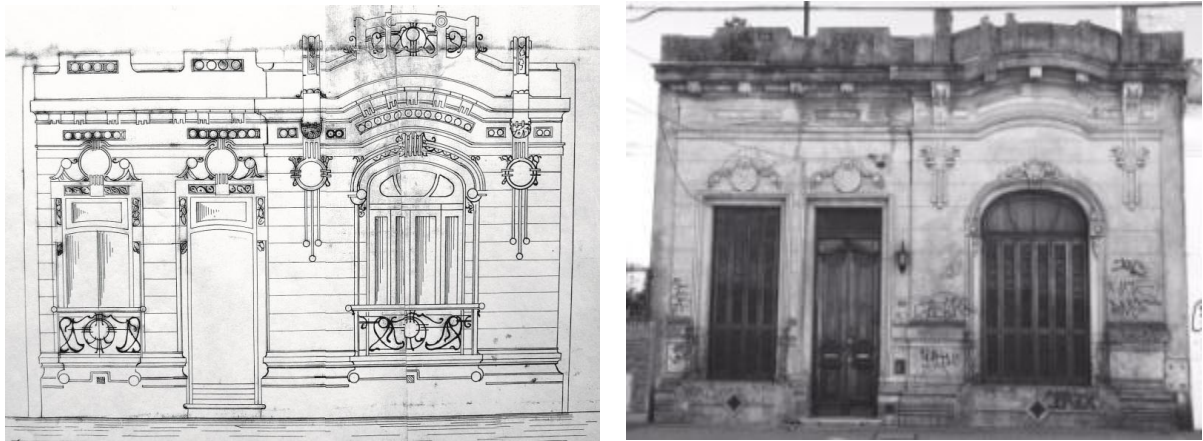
Detalles de fachada en proyecto Expte. D-22-1913.
